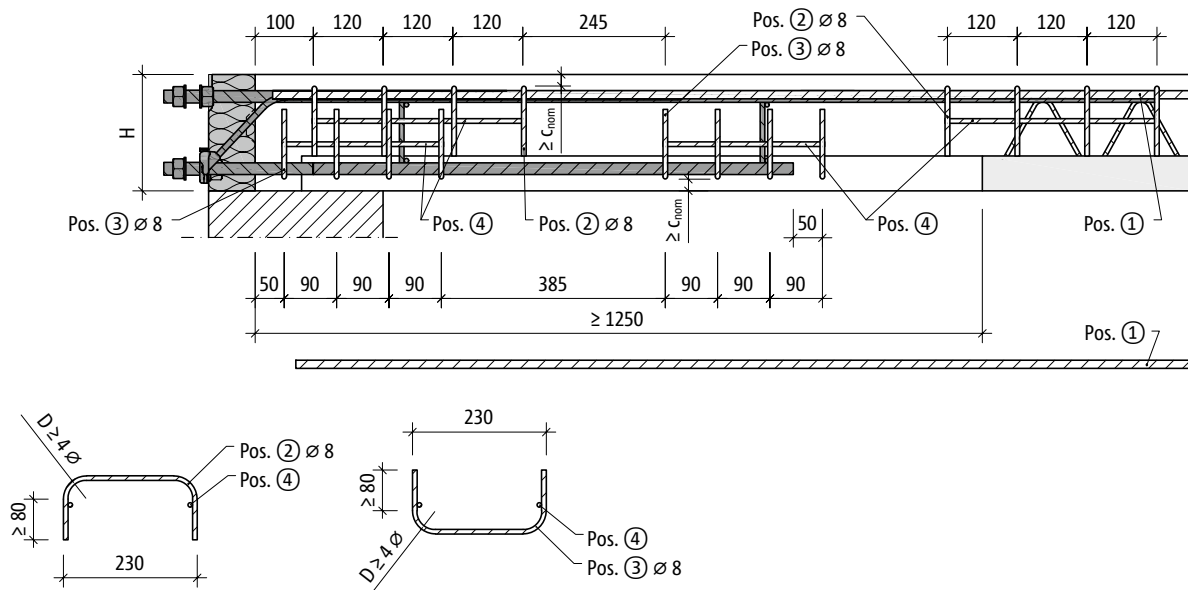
Schöck Isokorb® T Typ SKP-MM2: Bauseitige Bewehrung bei Halbfertigteilbauweise mit Bügel  $\varnothing 8$  mm; Schnitt
